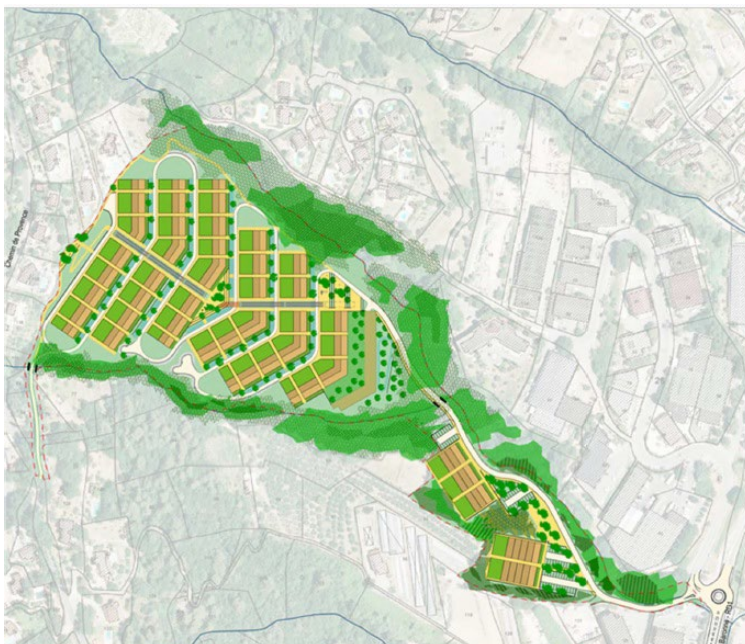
Plan masse du projet (source : dossier – figure sans légende)
